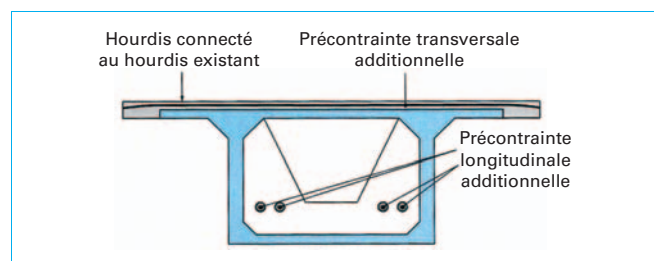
Élargissement de la dalle de couverture d'une poutre-caisson
